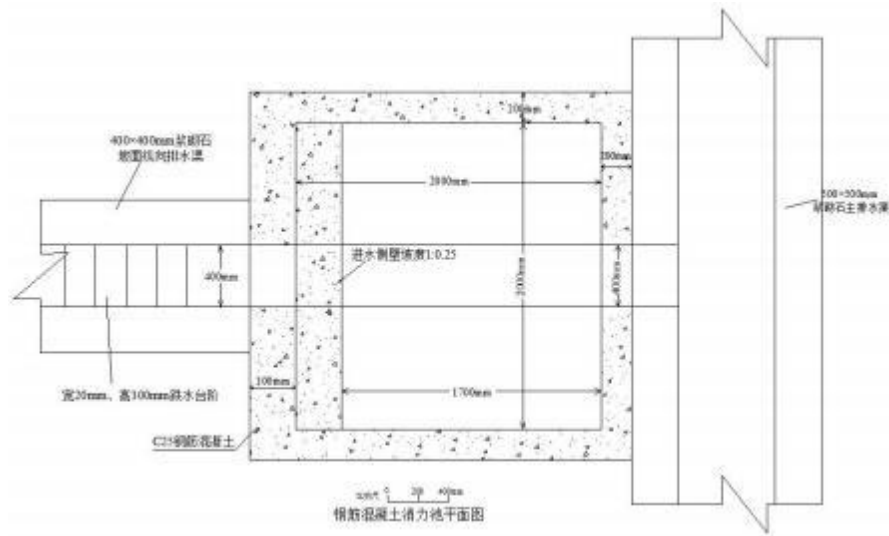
2000×2000mm 钢筋混凝土消力池平面图
